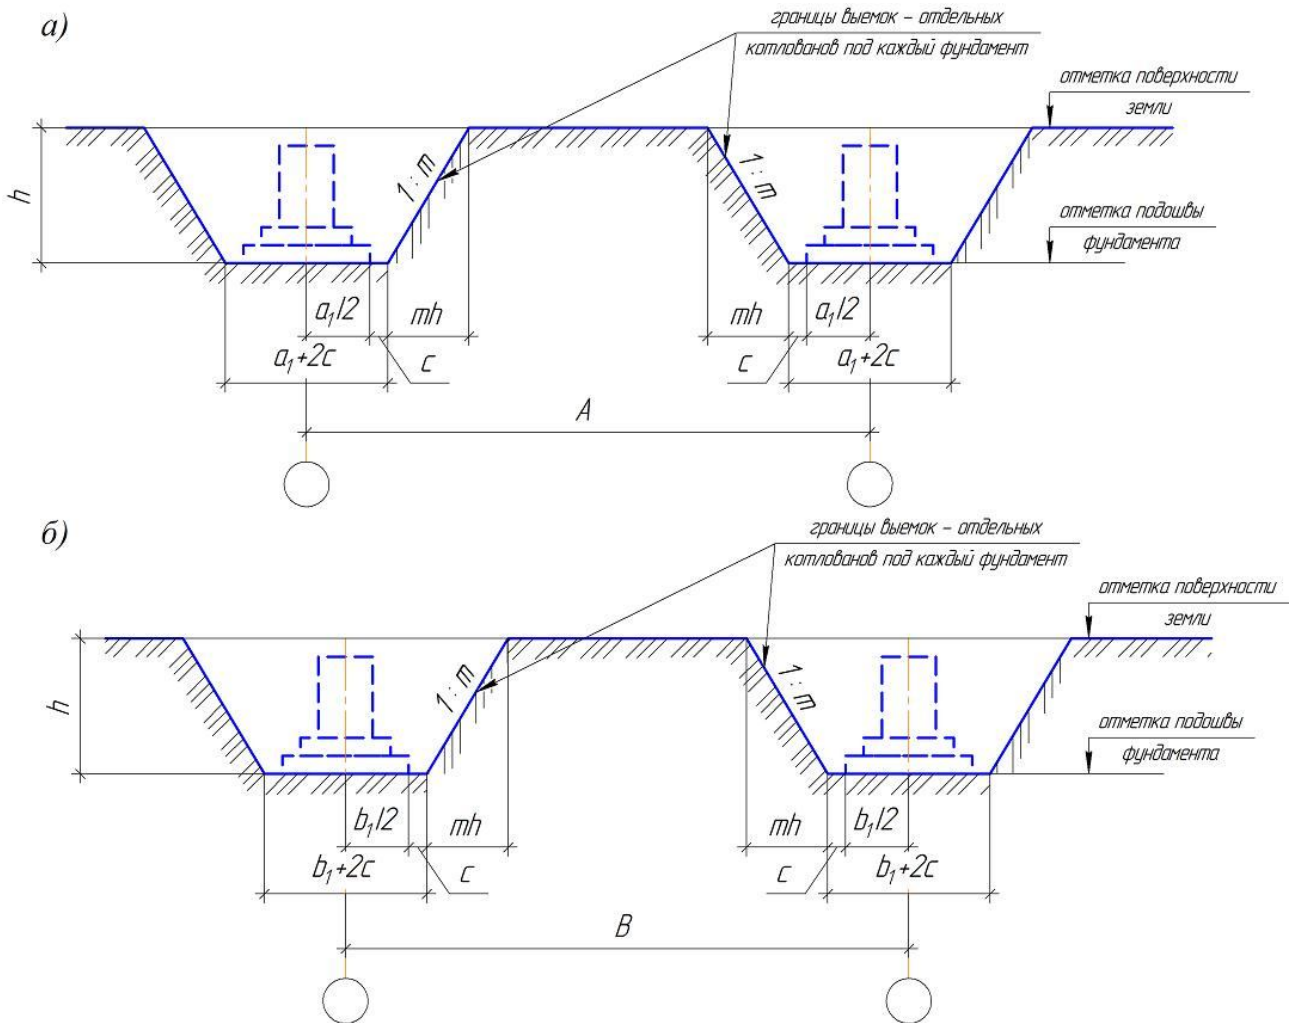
Разрезы по осям участков двух смежных фундаментов к выбору формы земляного сооружения: а) поперечный; б) продольный
